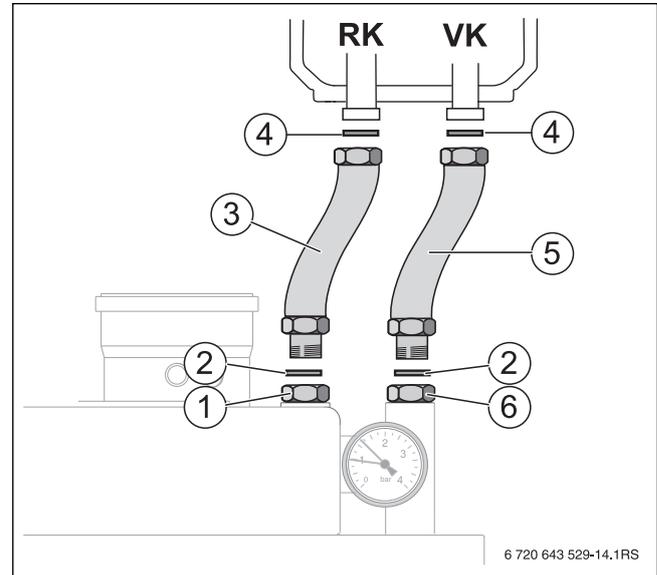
Anschluss-Set für Heizkreis-Set montieren
